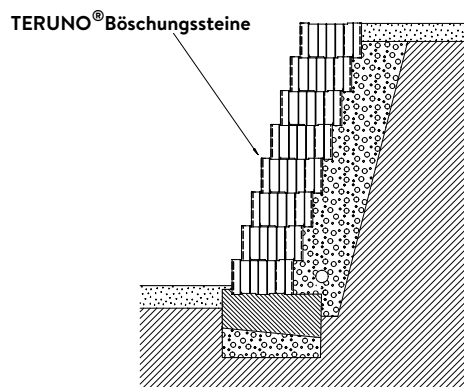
Aufbauquerschnitt 75°, Rücksprung 6 cm
